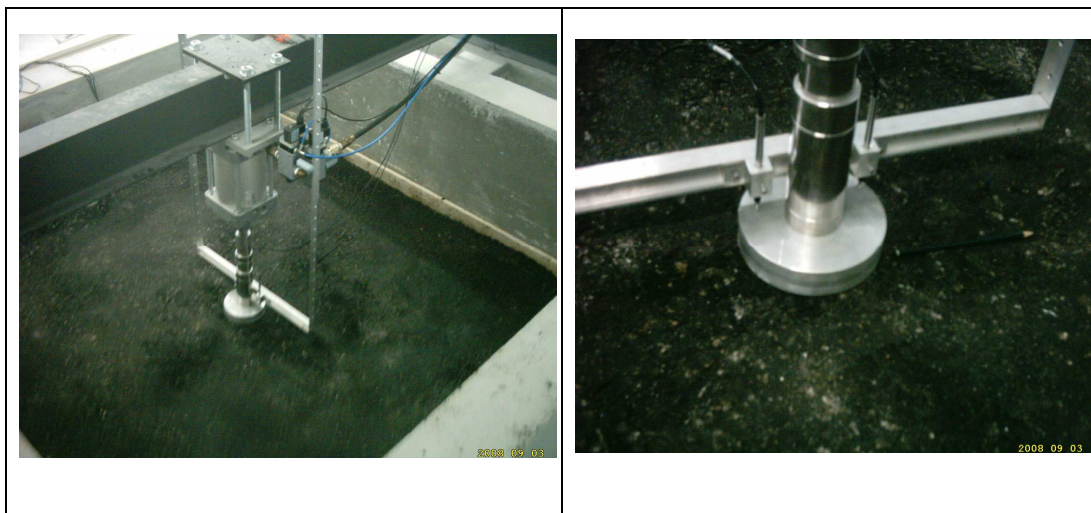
Detalhes do ensaio da estrutura do pavimento com revestimento tipo CBUQ.
